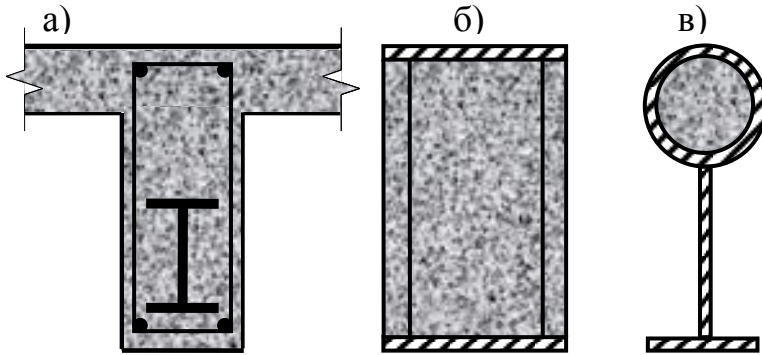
Поперечні перерізи сталезалізобетонних балок і ригелів:
